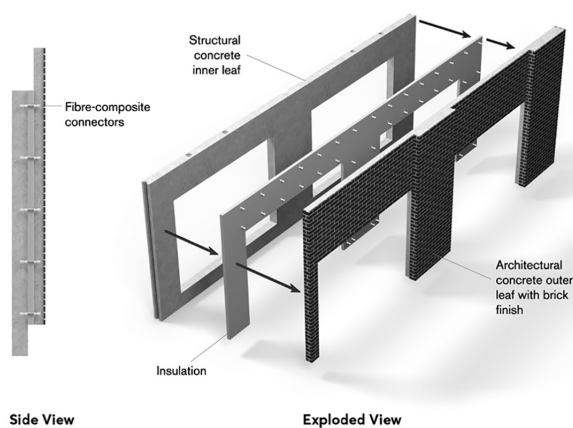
Архитектурные фасады из сборного железобетона компании «Bison Precast» [25]
